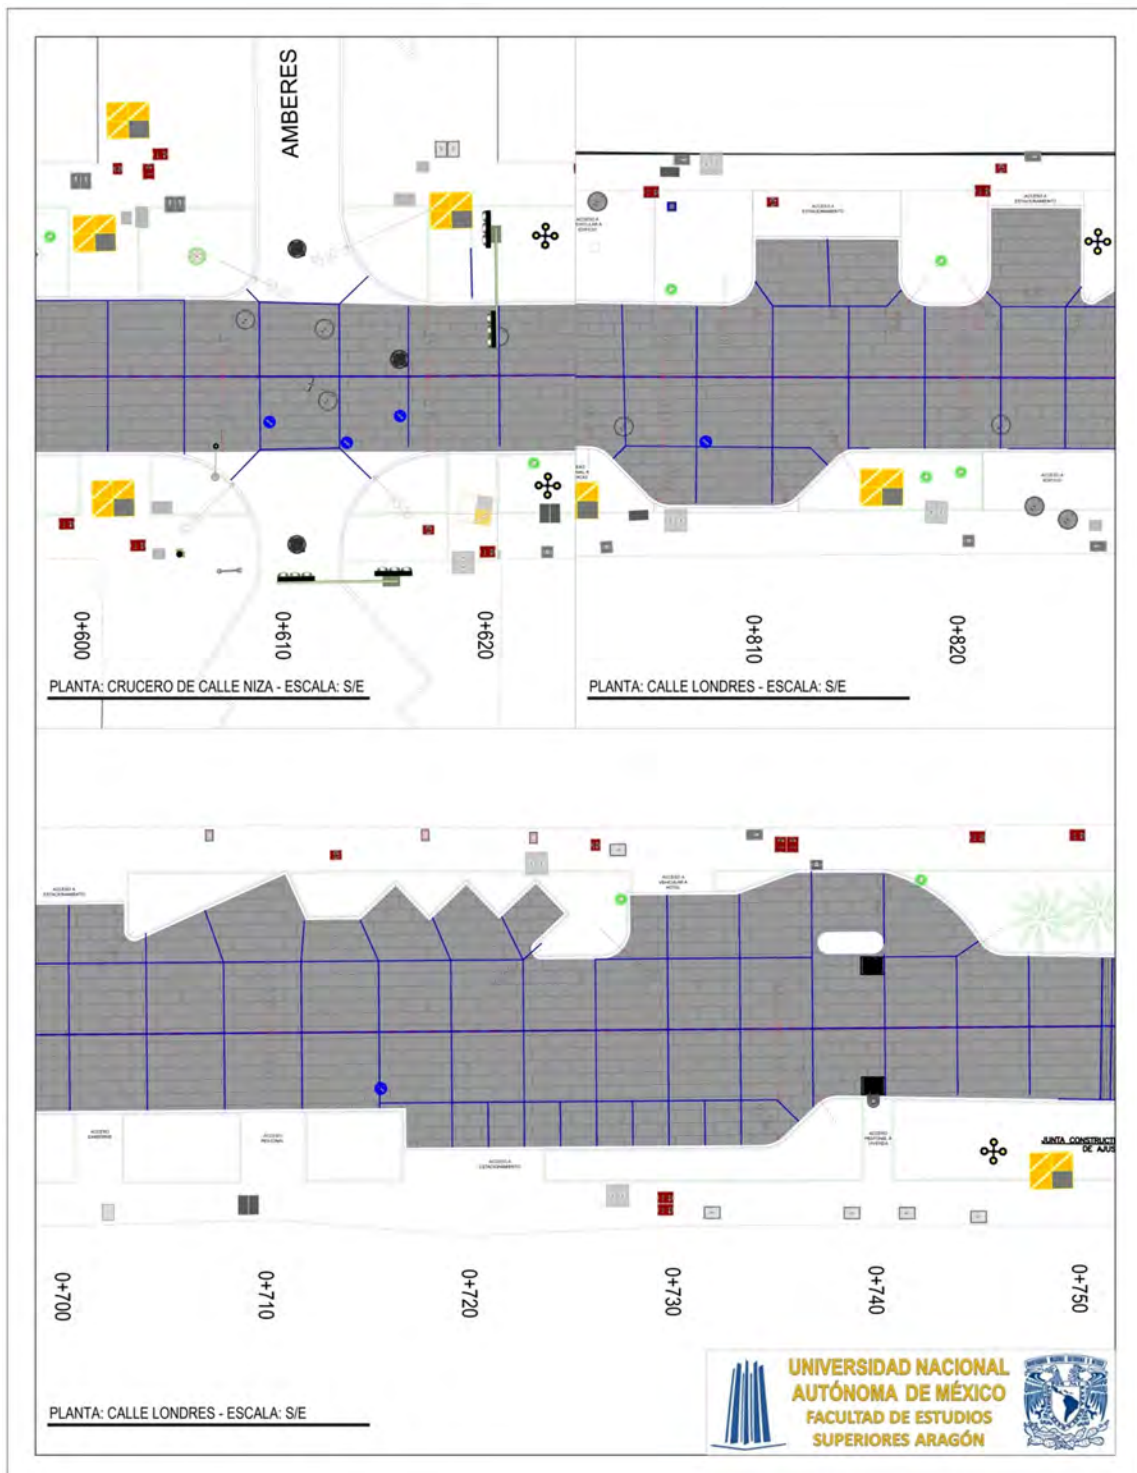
10 Ejemplo de modulación representando las juntas transversal y longitudinal y junta de aislamiento realizada en infraestructura como pozo de visita, de CFE, fibra óptica y rejillas de banqueta.
